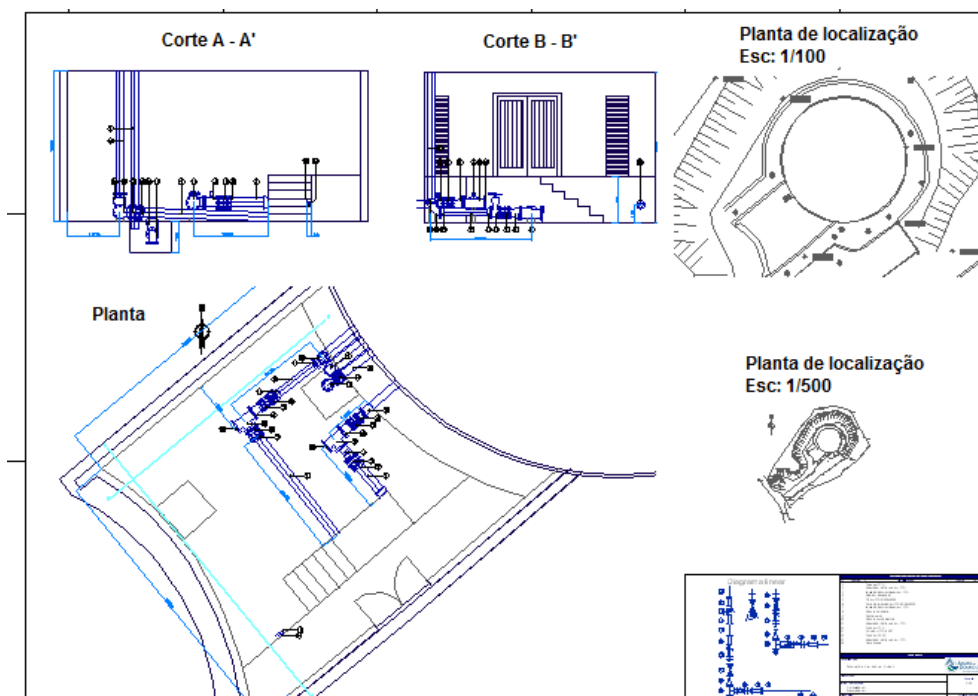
Tela final de planta (Reservatório de Castro Daire).
